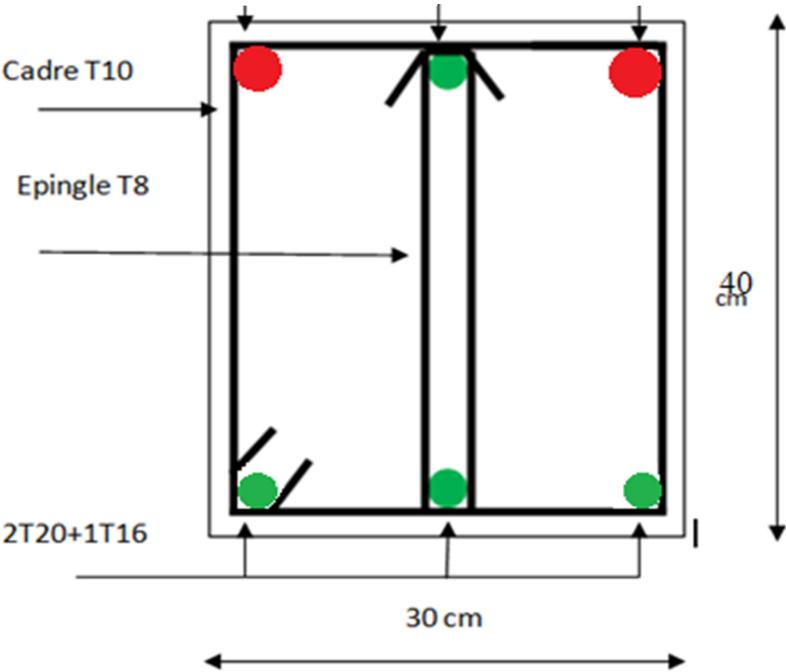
Schéma de ferrailage d'une poutre principale en appui
